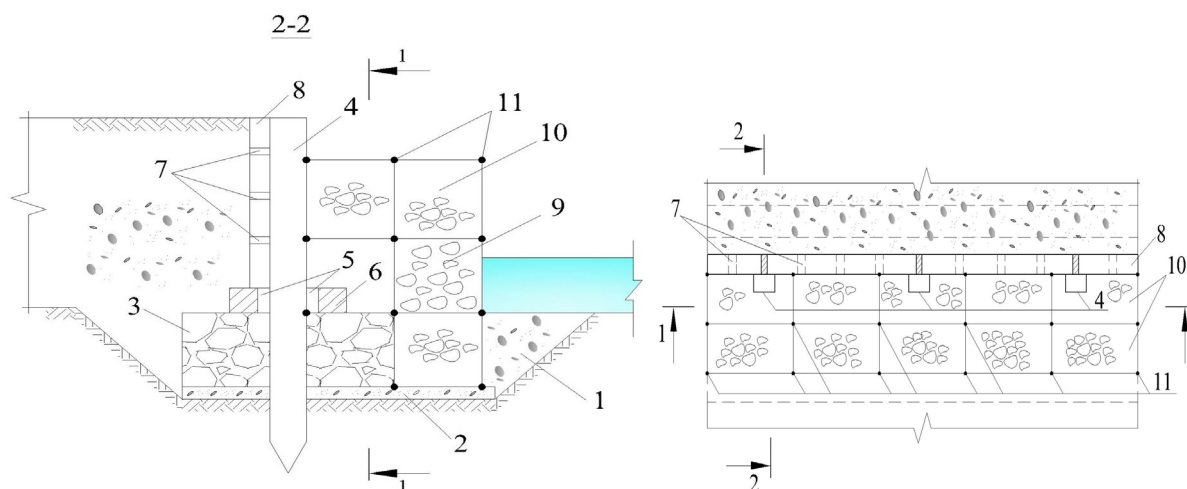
План и разрезы берегоукрепительные сооружения: русло реки – 1, слой бетонной подготовки – 2; каменная наброска -3; железобетонная опора (свая) – 4; отверстия -5; бетонная плита - 6; отверстия - 7; железобетонная плита - 8; камень - 9, металлический ящик - 10; узлы – 11.
